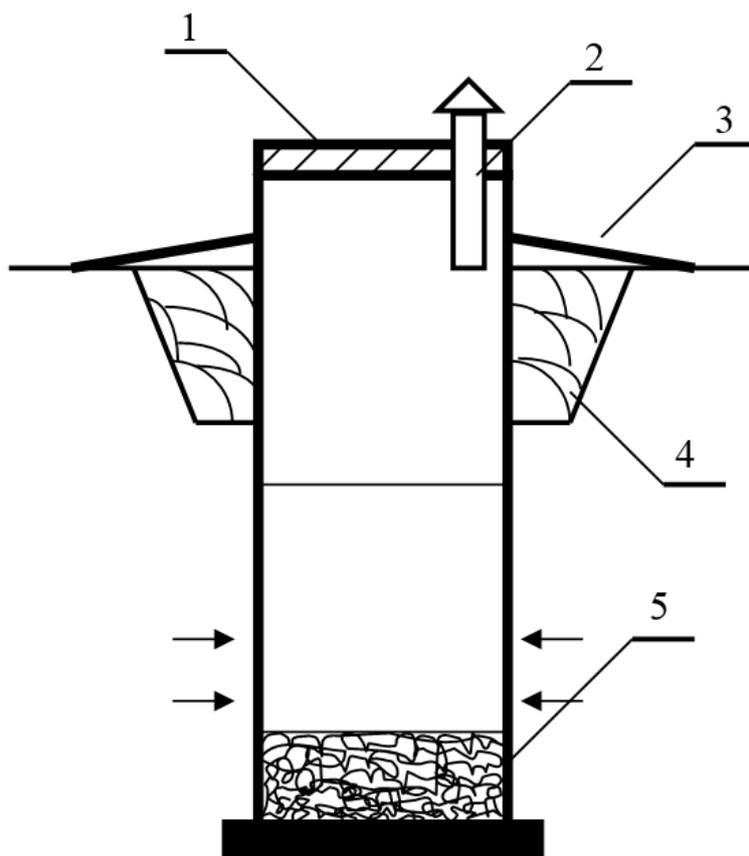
Шахтный колодец из железобетонных колец:
